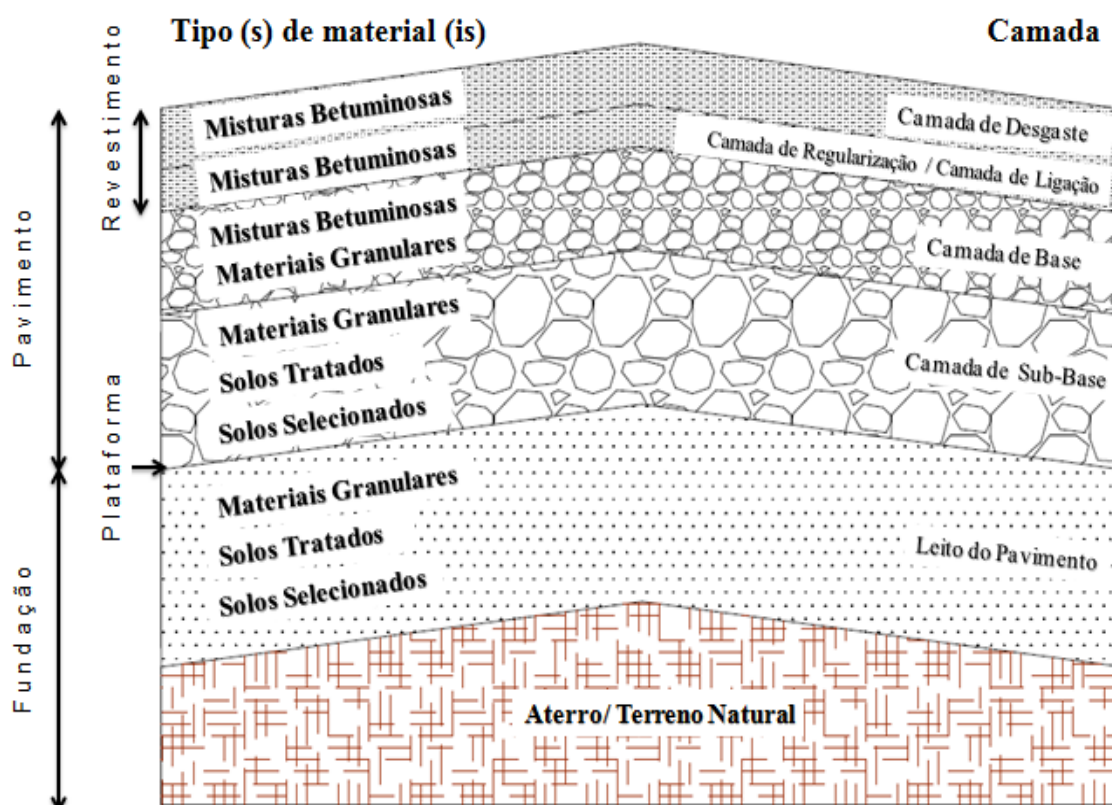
Estrutura de um pavimento flexível [adaptado de (Fonseca, 2011)]
